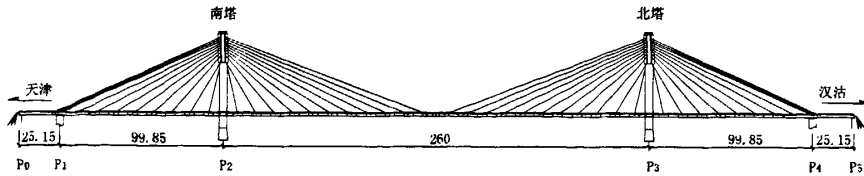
永定河斜拉桥立面布置示意图 (单位: m)
